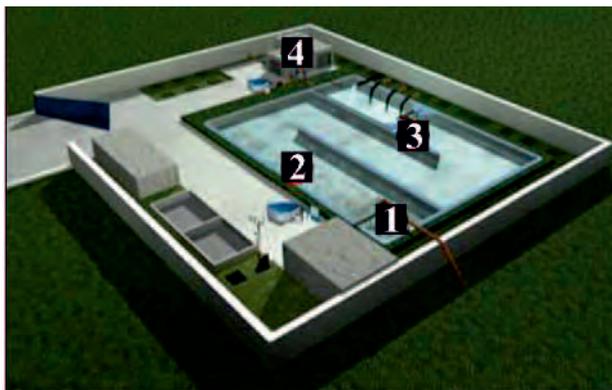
Rendering dell'impianto di affinamento di Fasano (BR).
